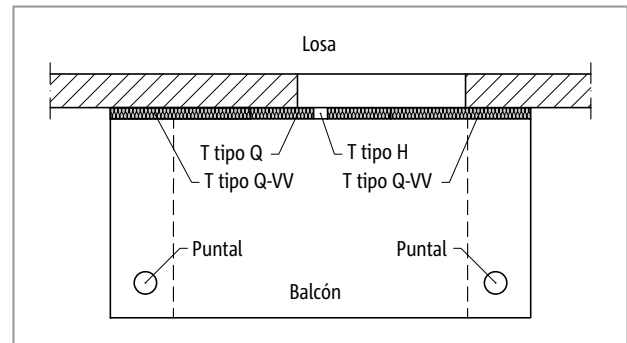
Schöck Isokorb® T tipo Q, Q-VV: Balcón apoyado con diferentes rigideces del soporte; T tipo H (opcional) con fuerza horizontal prevista
